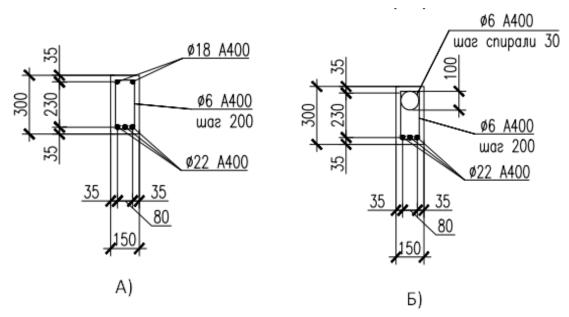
Схема армирования испытуемых образцов. A) — стержневое армирование Б) — спиральное армирование
